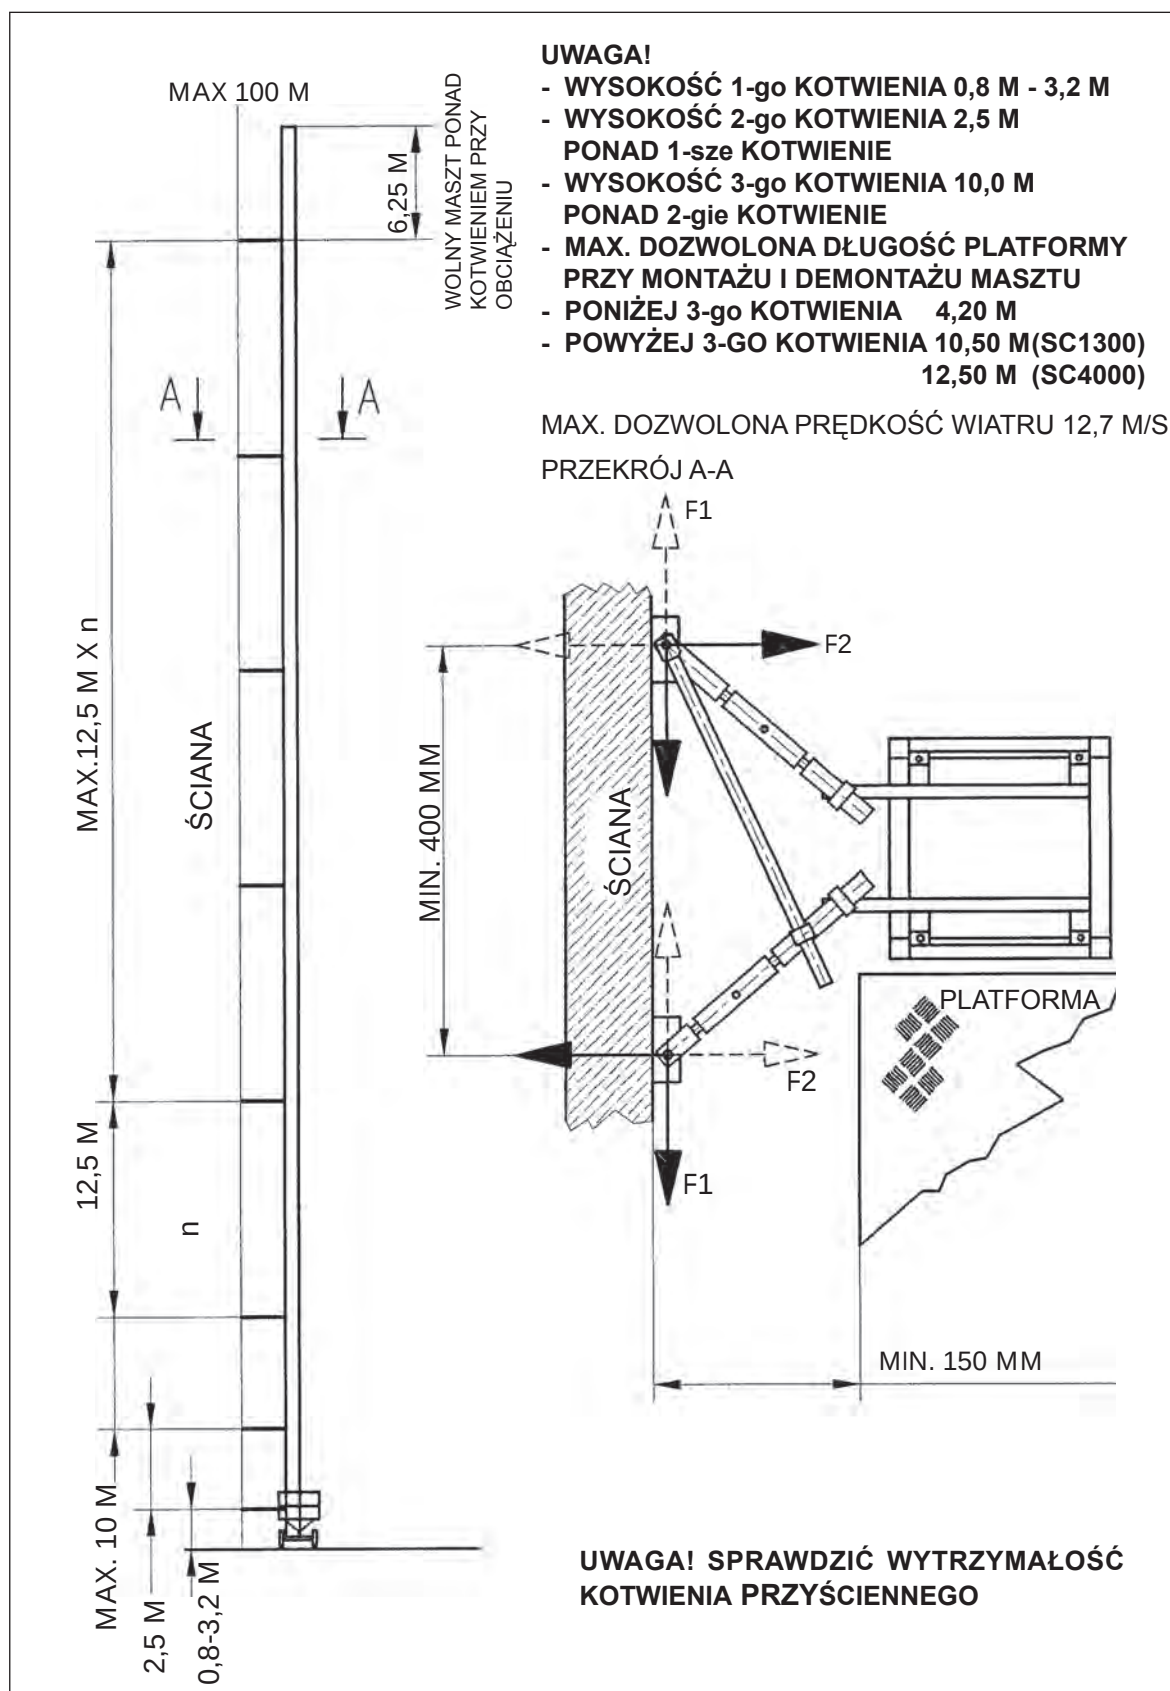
Instrukcje kotwienia przyściennego z kotwieniem szczytowym.
